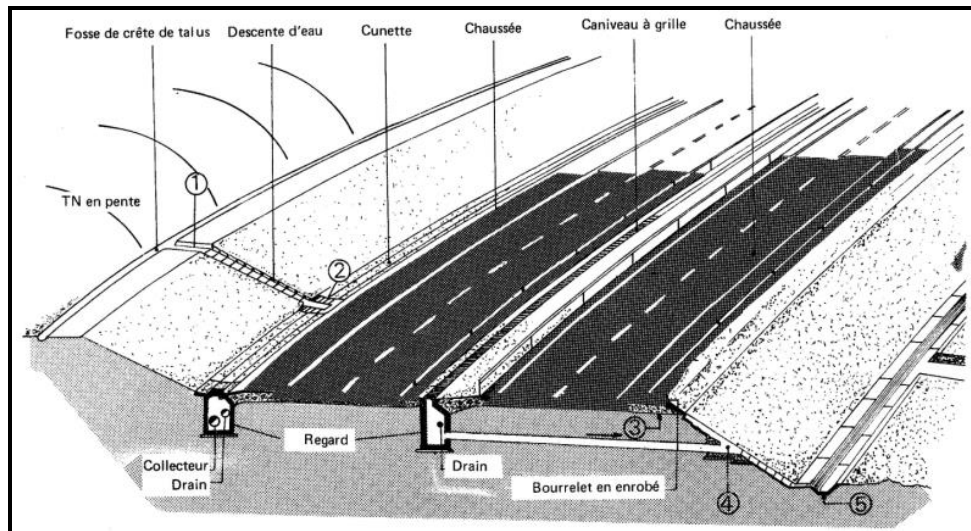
Schéma général des ouvrages d'assainissement d'une route.
